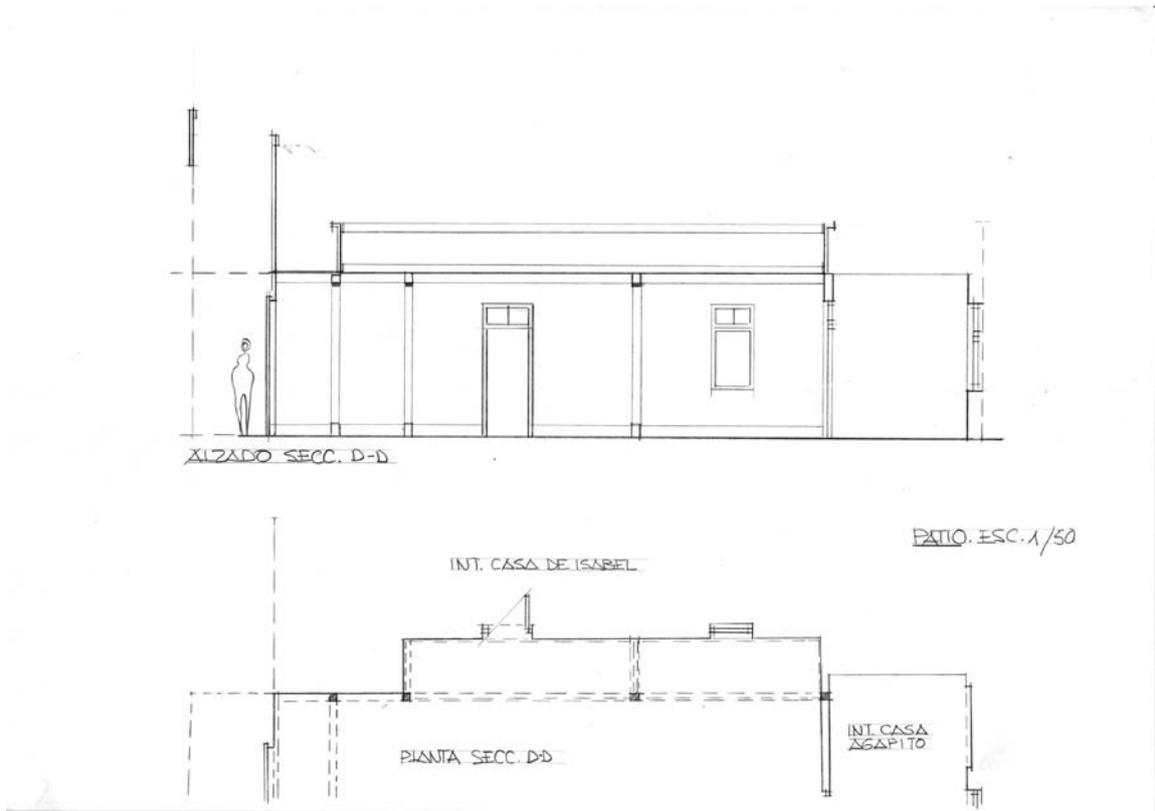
Planta y alzado de la casa de Isabel. Tinta sobre papel DIN-A2.
